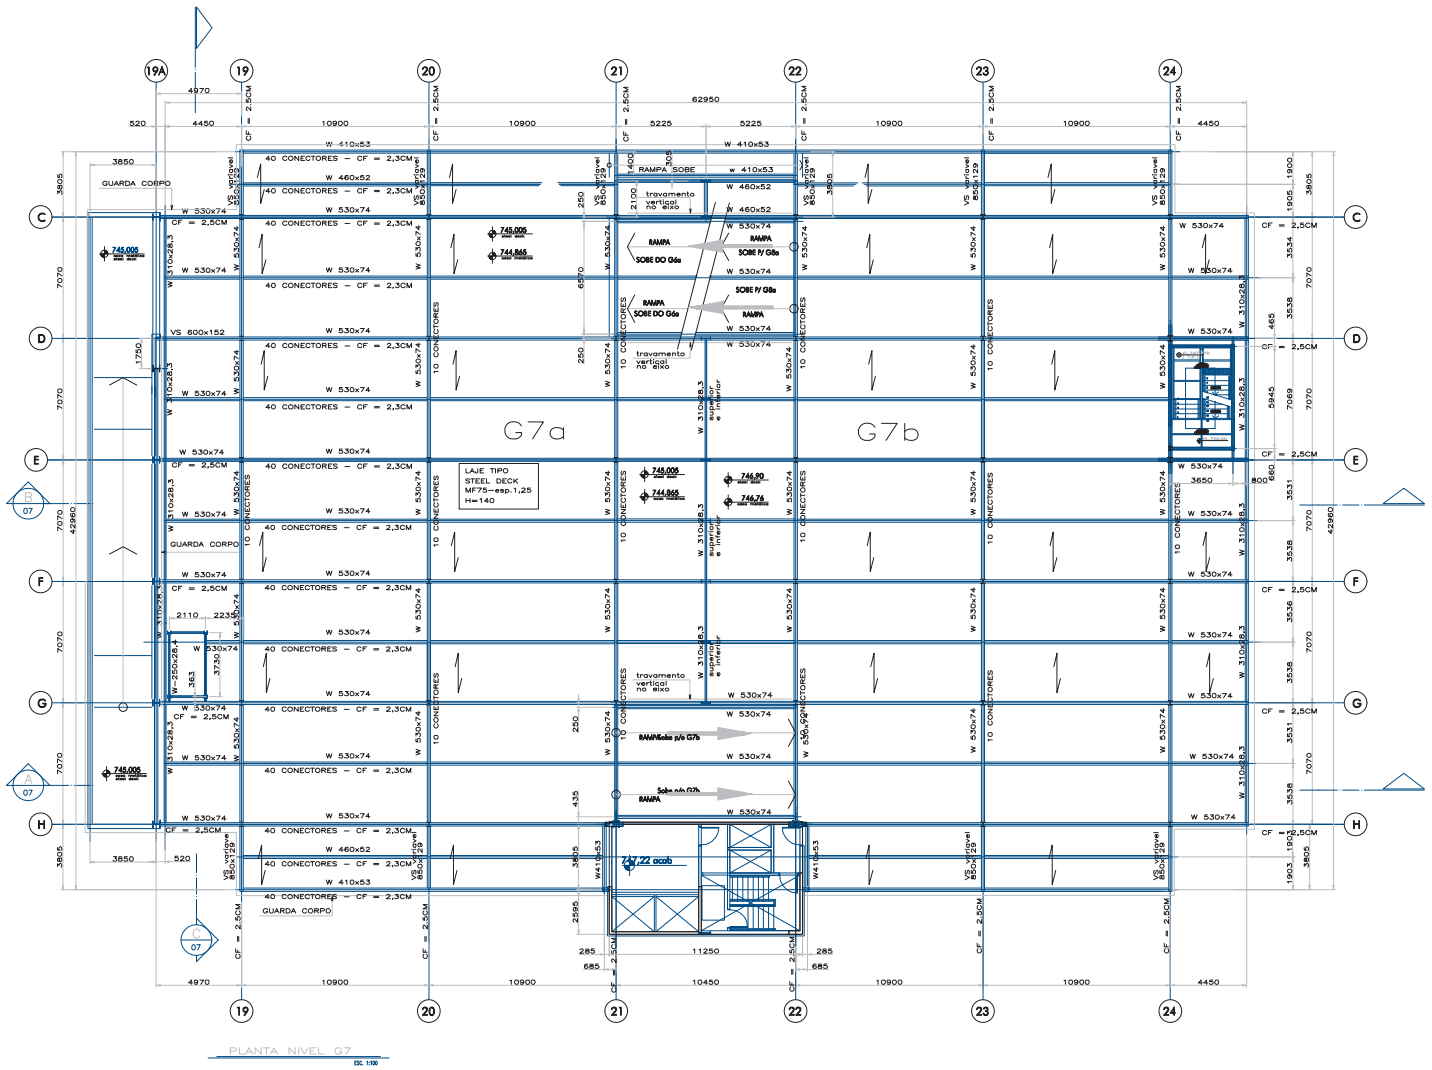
Posicionamento de vigas e pilares da estrutura metálica
